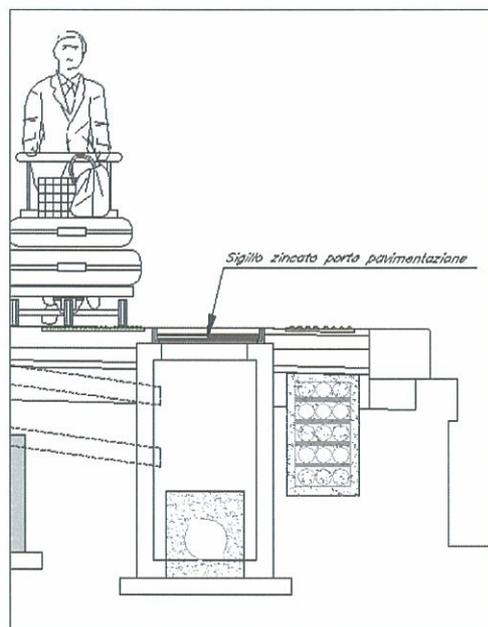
Sezione banchina con pozzetto ispezione collettore e relativo sigillo di chiusura
